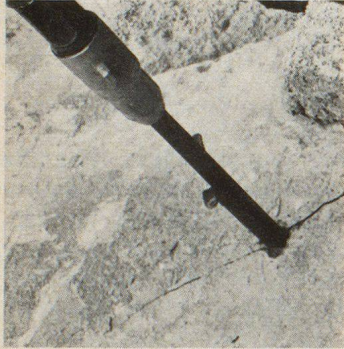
Spaltkeil mit Abbauhammer A 7 im Bohrloch
